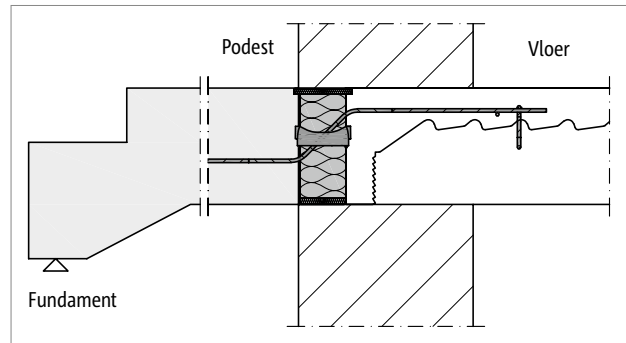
Schöck Isokorf® T type Q-E: Aansluiting bij buitenisolatie
